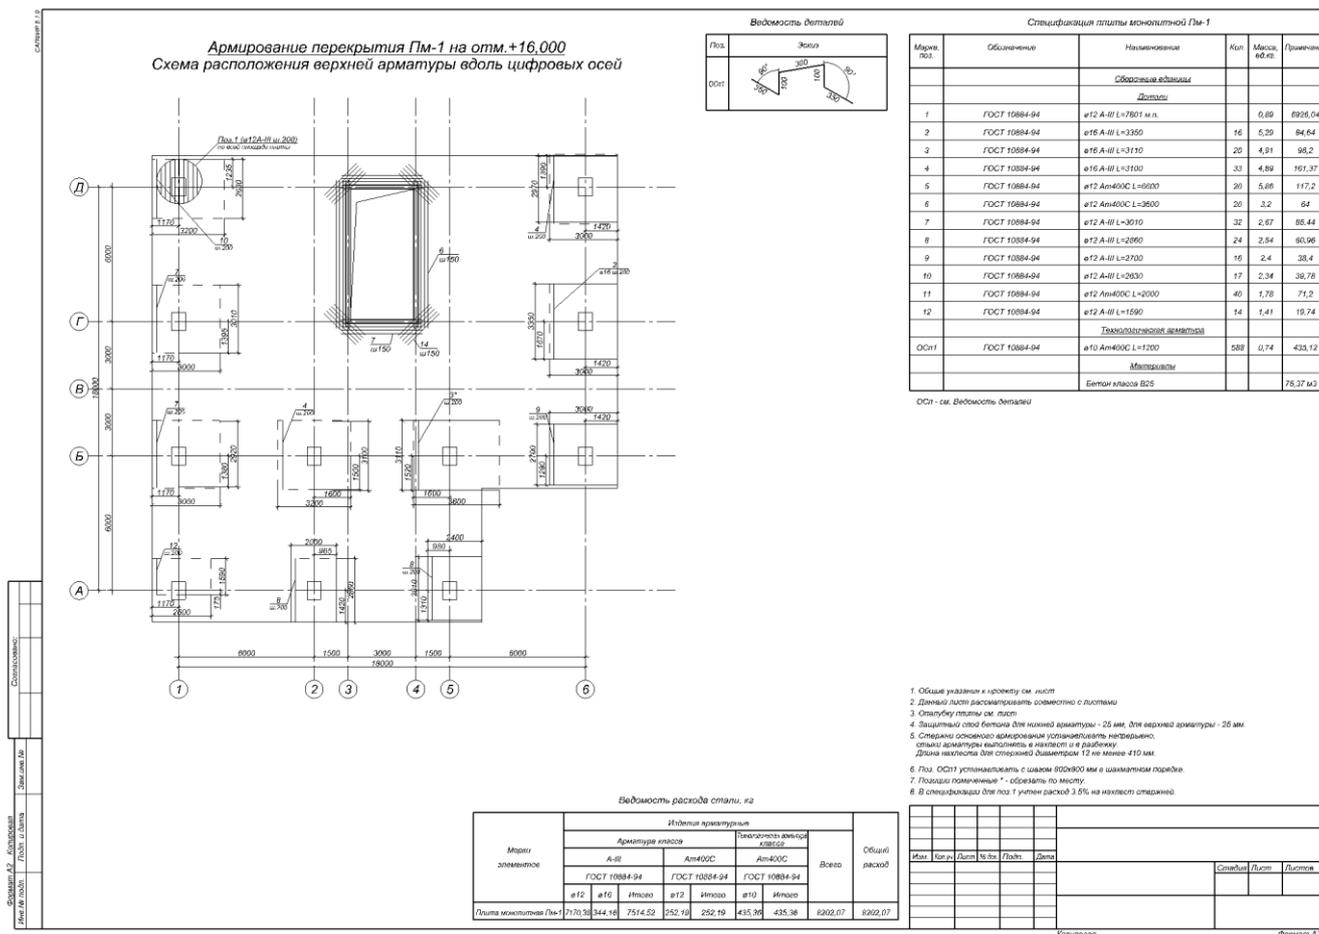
Чертеж расположения арматуры в плите перекрытия на отметке +16.000
